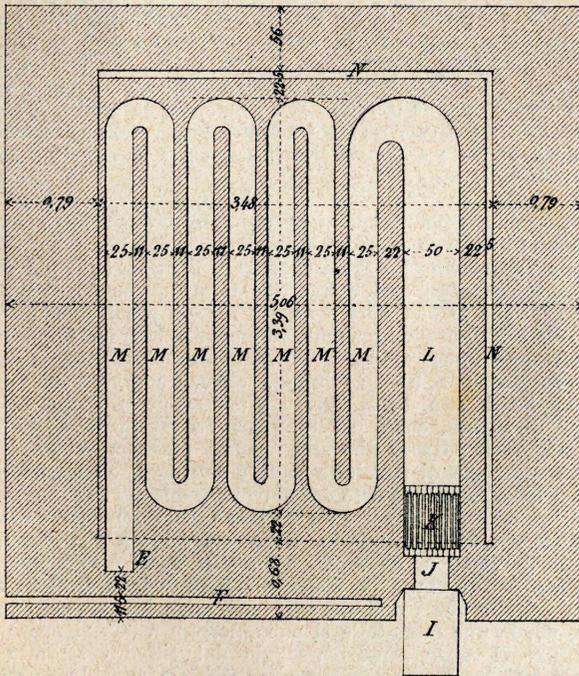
Sezione orizzontale dell'apparecchio di riscaldamento.
